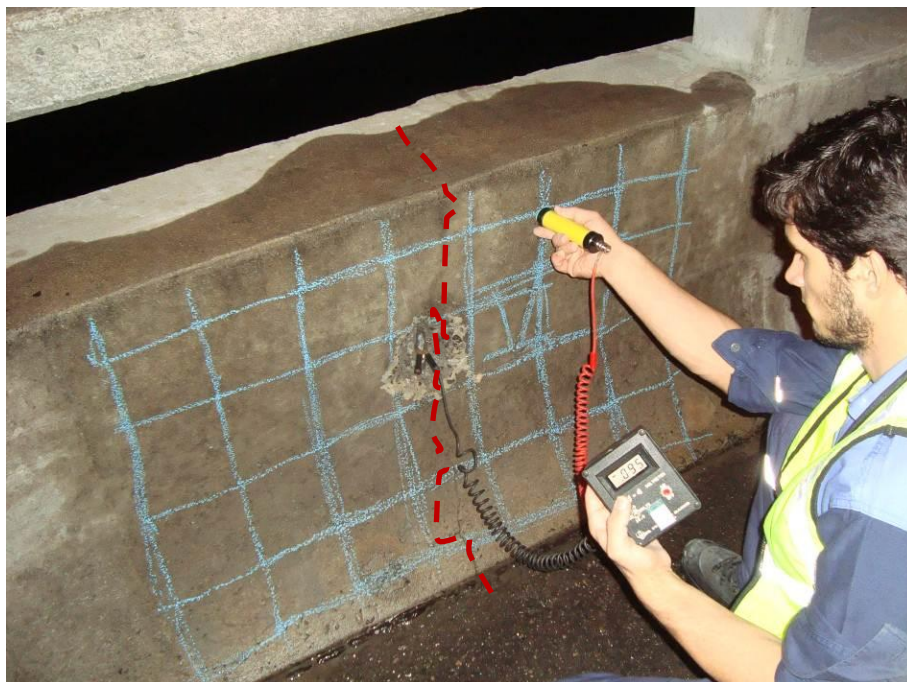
Local escolhido para o ensaio V, sobre fissura.
